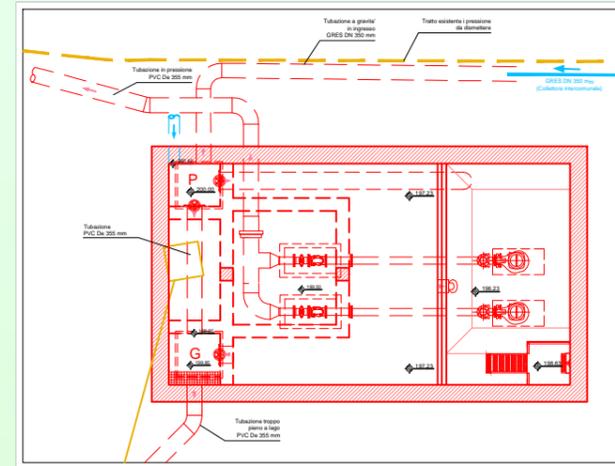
Stazione di sollevamento S.S.6 - Pianta
